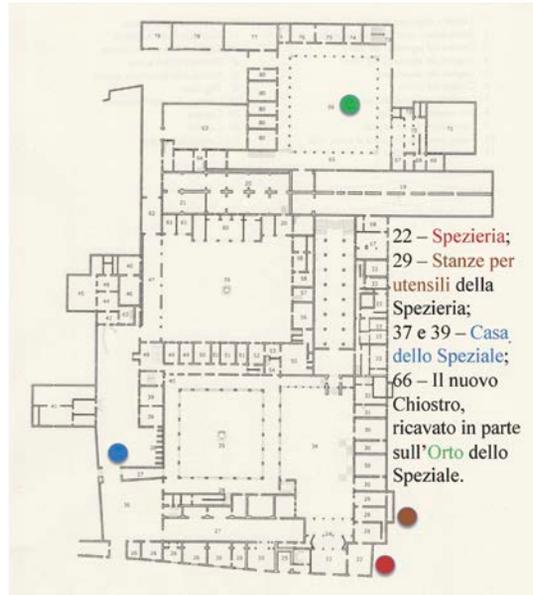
Pianta ottocentesca dell'Ospedale. Ipotesi di distribuzione funzionale dell'Arcispedale S. Anna nella seconda metà dell'Ottocento: rielaborazione della planimetria del pianoterra (e parte del seminterrato) basata sulle planimetrie di Gaspare Buratti, del perito Pietro Colla e su disegni di progetto per il terzo chiostro dell'Ing. Biondini.
